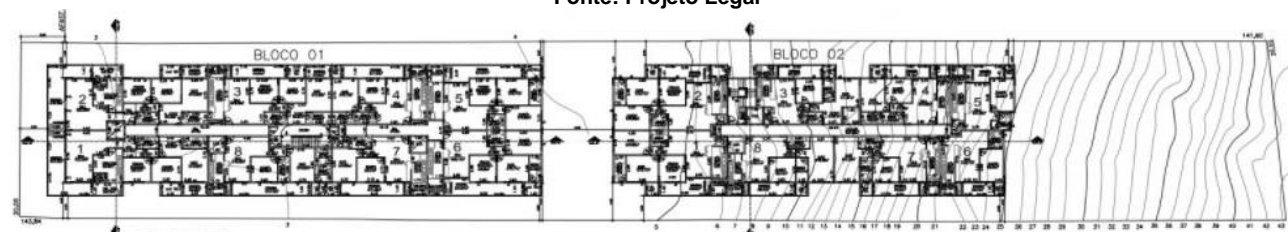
Pavimento Tipo (5º ao 11º) – Blocos 01 e 02.
